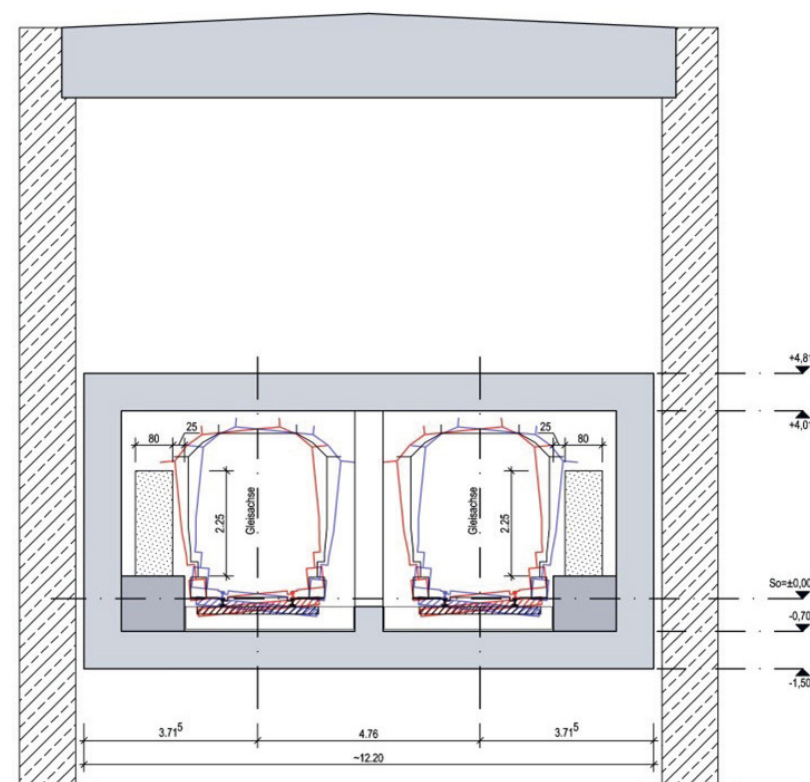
Streckentunnel 2-Gleisig (Deckelbauweise)
